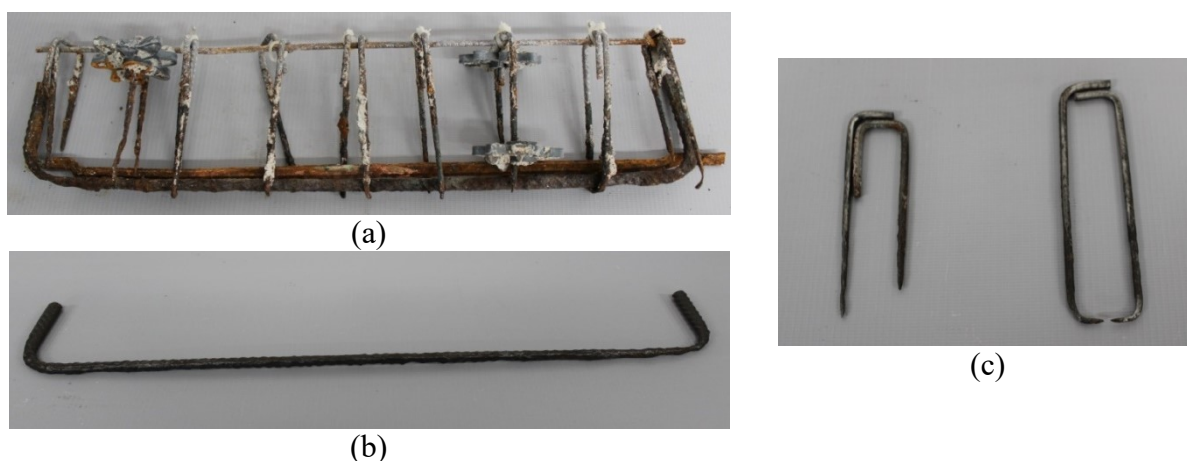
Armaduras: (a) após remoção do concreto e armaduras (b) longitudinal e (c) transversal após processo corrosivo. Fonte: Autoria própria
